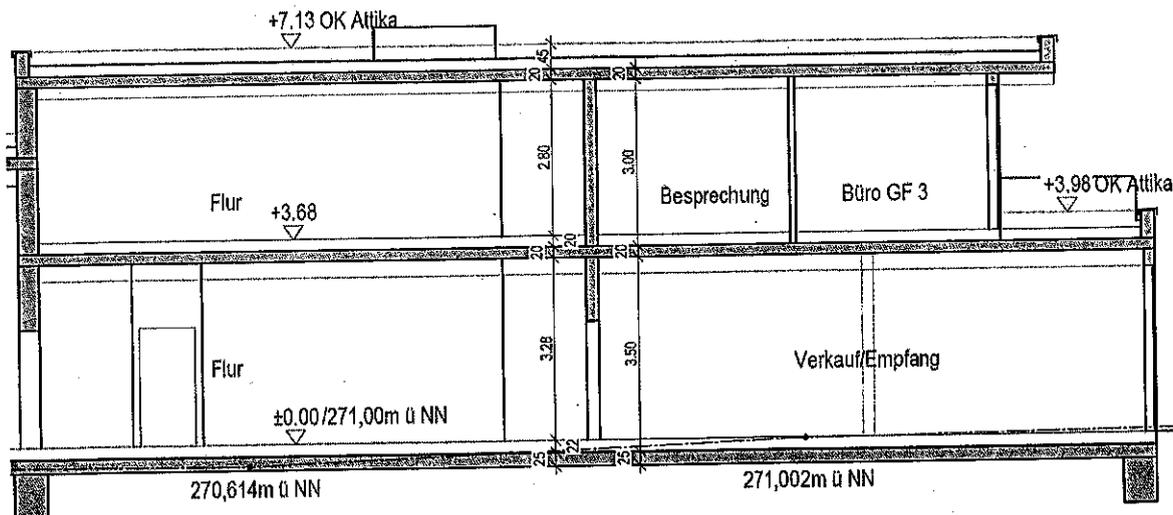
Beispiel 2-geschossiges Bürogebäude
